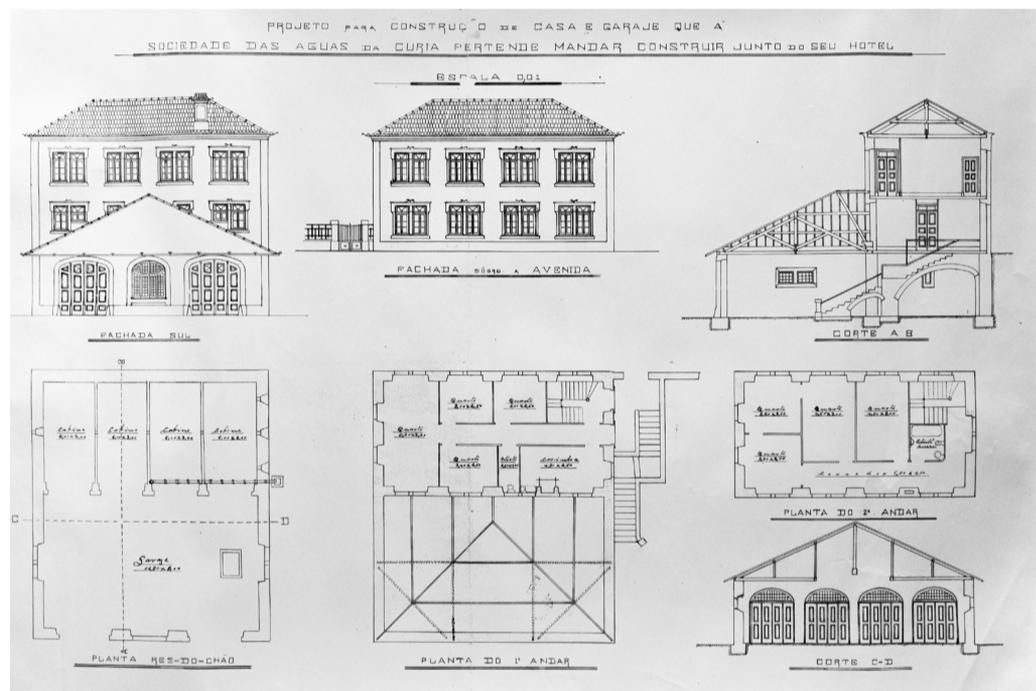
| Planta para a construção de uma casa e garagem a construir pelo mestre de obras Francisco Leandro Cardoso (1926).
